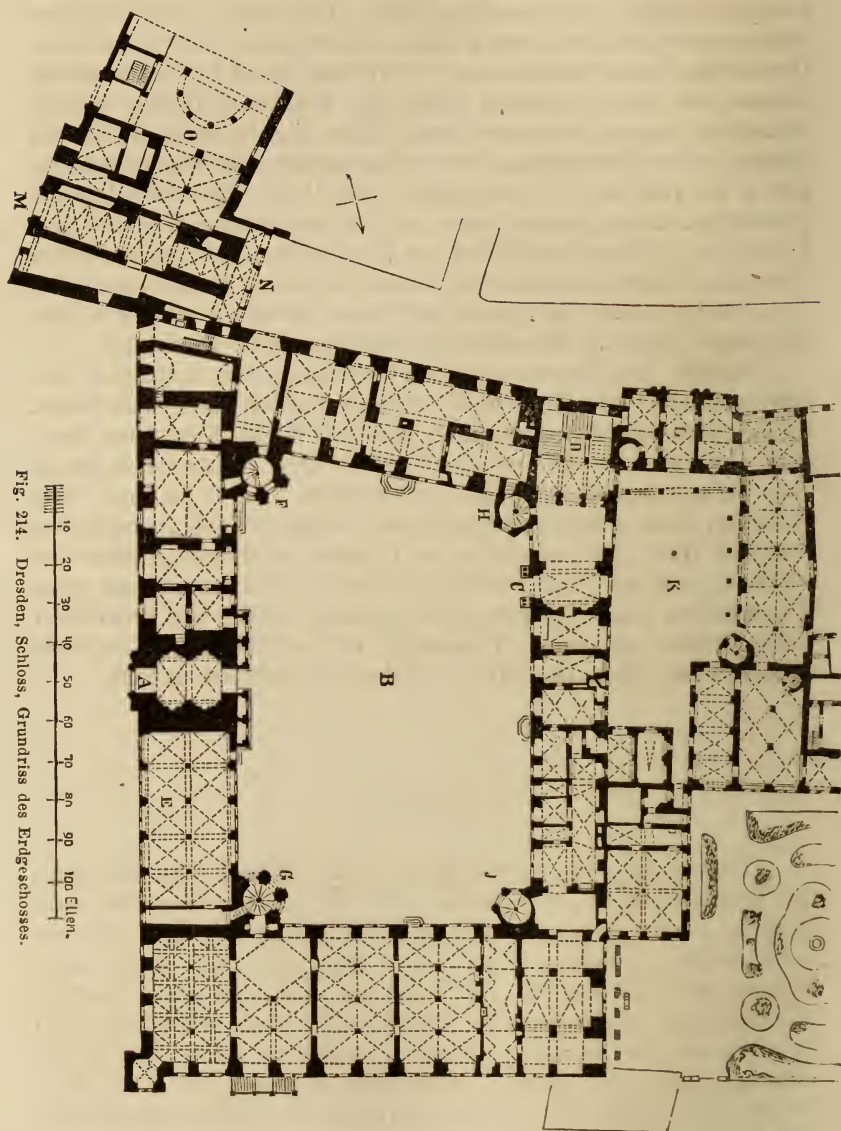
Dresden, Schloss, Grundriss des Erdgeschosses.
